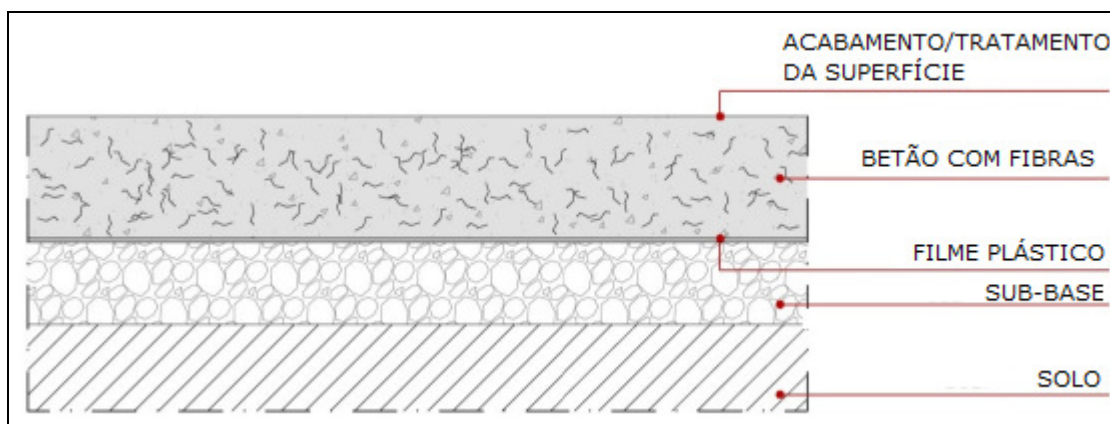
Corte: Pavimento industrial de betão reforçado com fibras (Cristelli, 2010).
